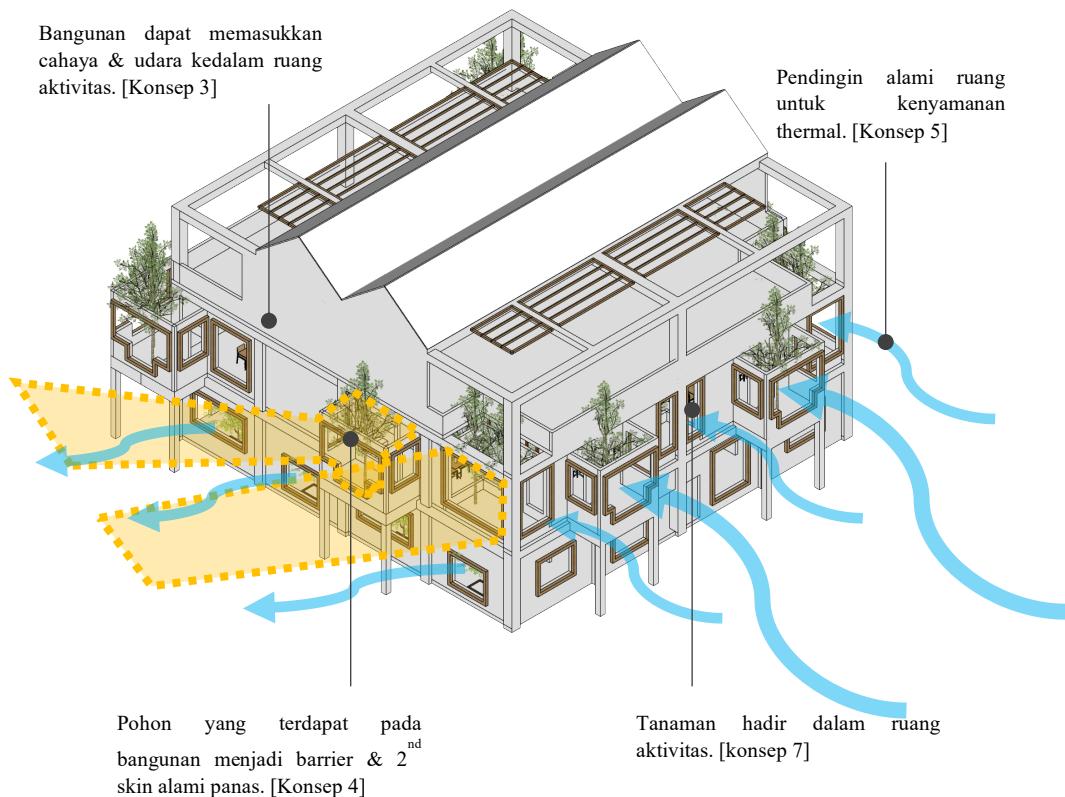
Konsep bangunan adaptasi bangunan heritage, Sumber : Dok.Pribadi.
